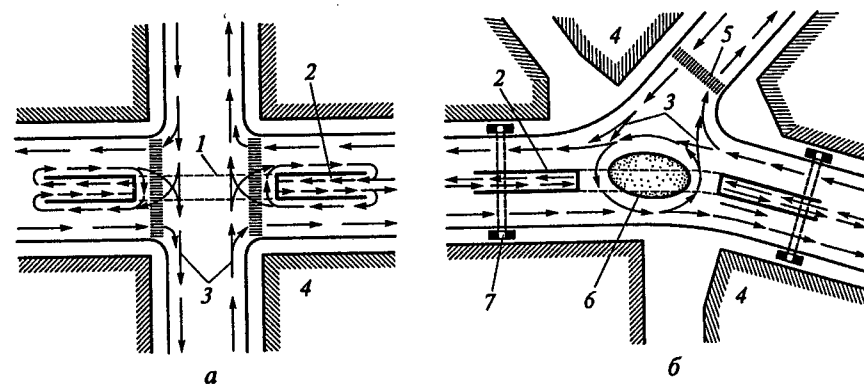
Планировочные схемы транспортных тоннелей на прямом пересечении (а) и У-образном примыкании (б) магистралей:
